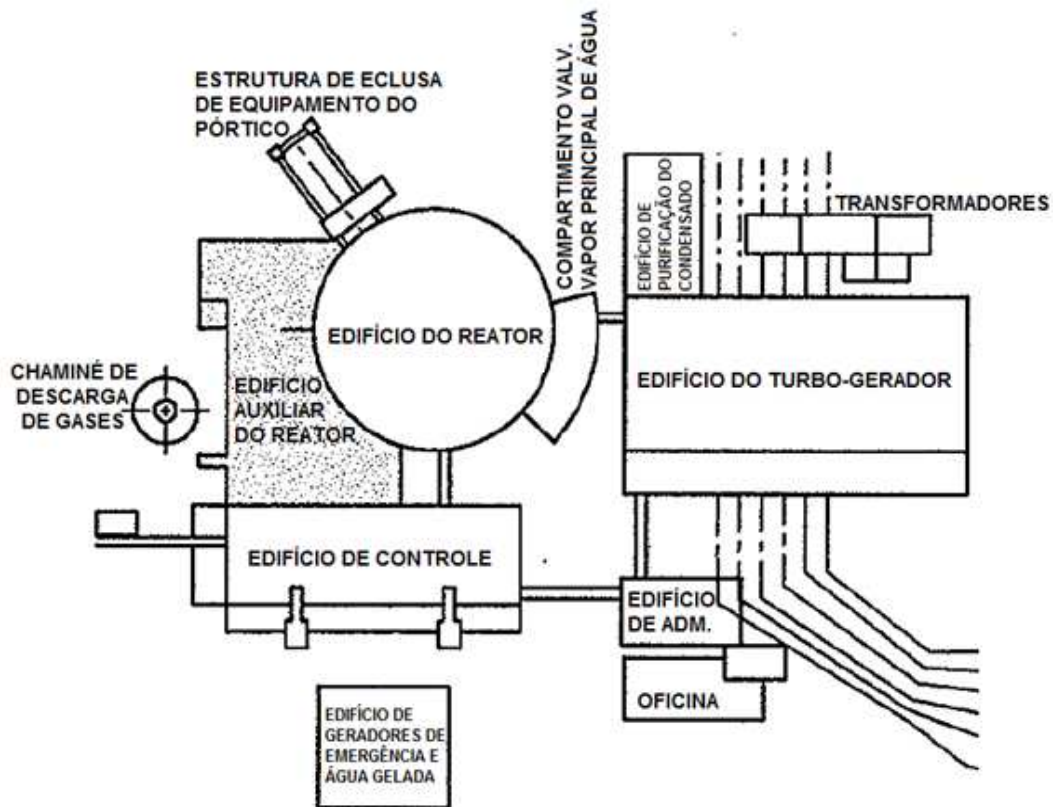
Planta esquemática da Usina Angra 3. Fonte: adaptado de [3]
